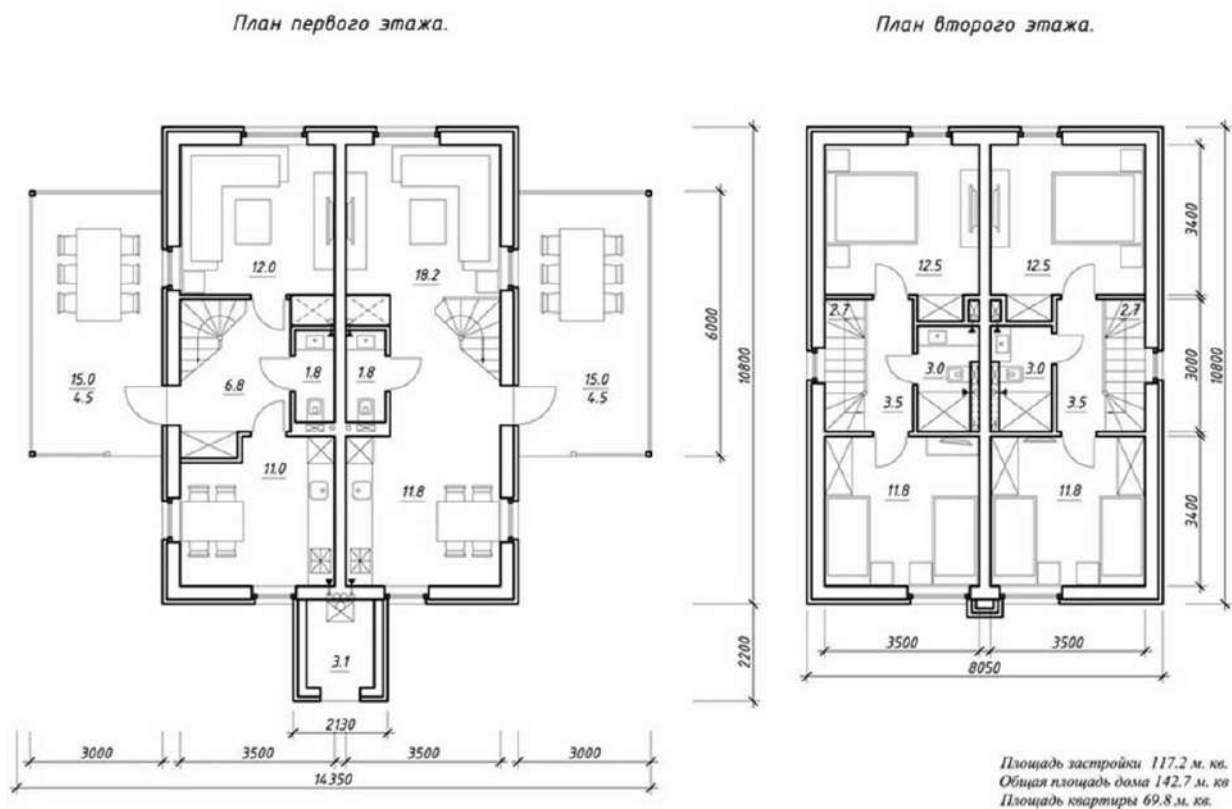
Пример поэтажных планов секции блокированного жилого дома
